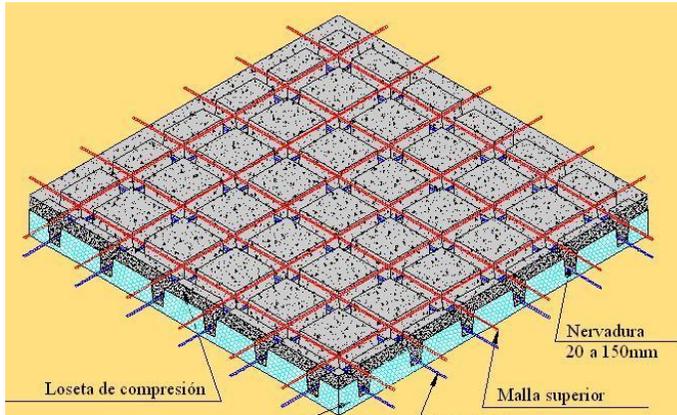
Estructura de loseta que presenta AISLAPOL S.A.
